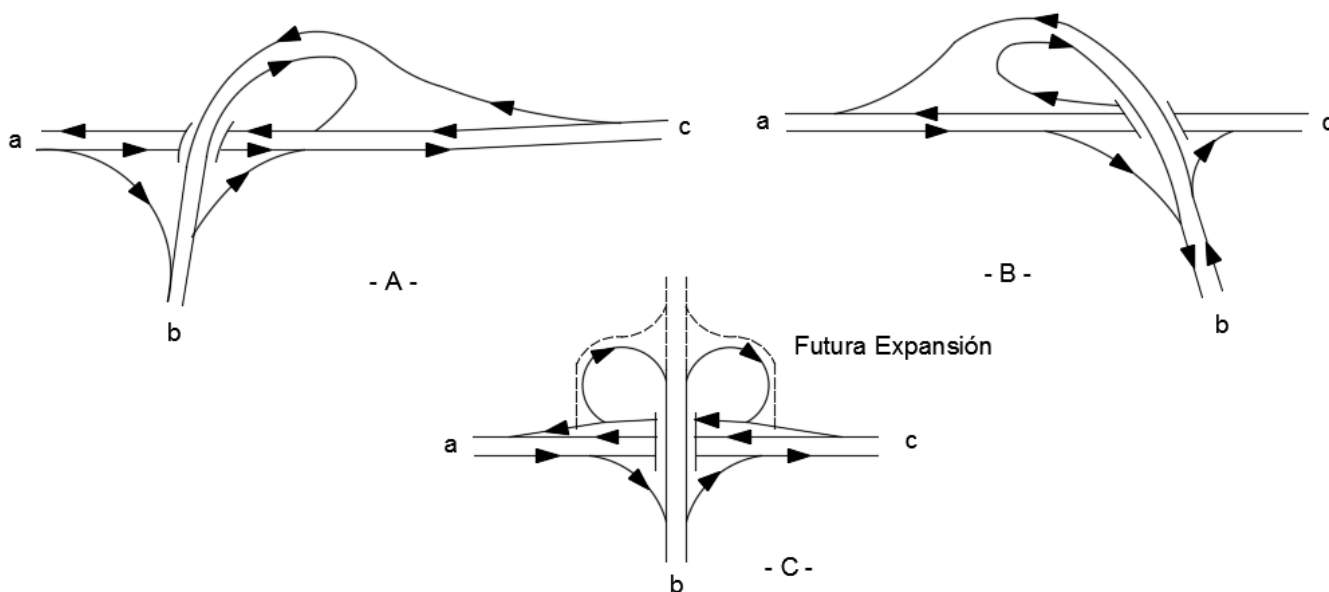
Intersecciones de tres ramas con una estructura
